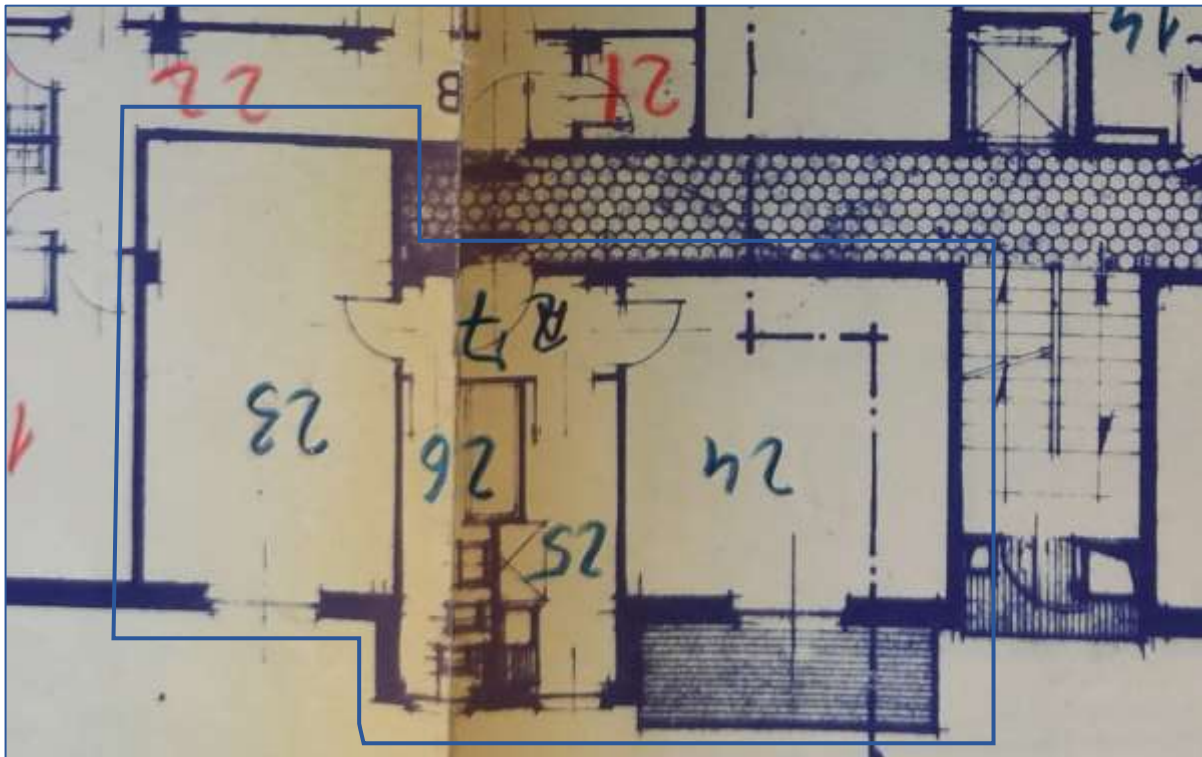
Estratto tavola di progetto atti di fabbrica - appartamento
